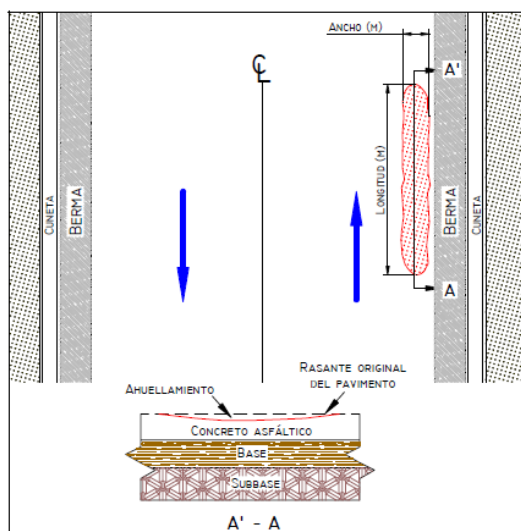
Ahuellamiento con deterioro avanzado sobre pavimento asfáltico existente.
